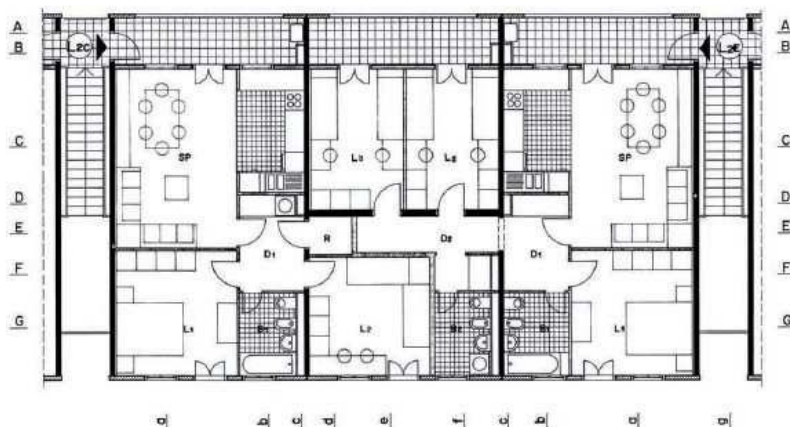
Pianta tipo edilizia bassa di Pazzigno
